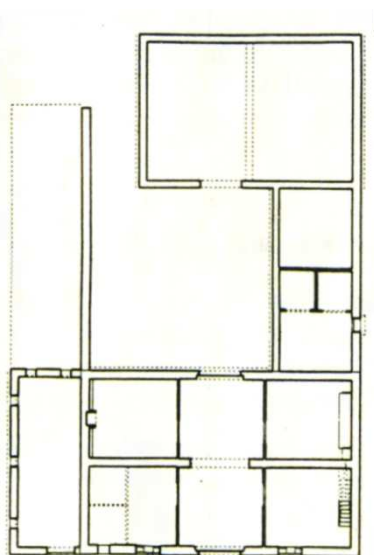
Planta de la Alquería del Pi en el Carraixet, Cases de Bárcena. Título del Libro: Arquitectura Rural Valenciana.
